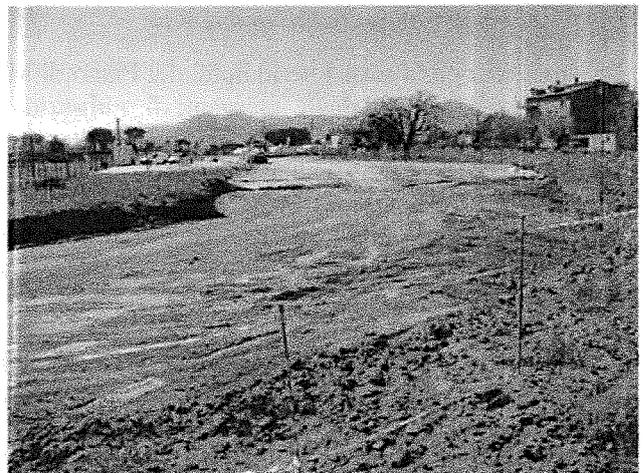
Altro dettaglio dell'Area scavo 2 - Area Ovest
